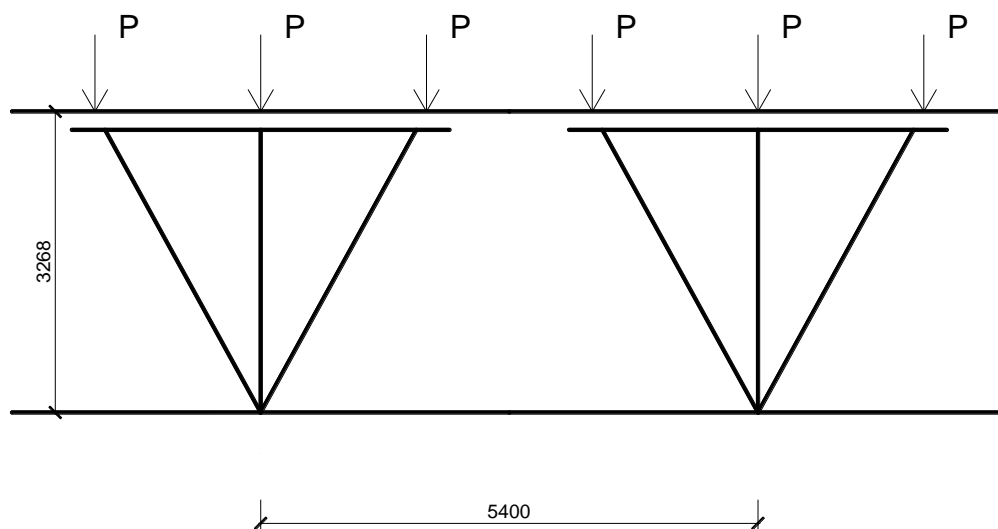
Розрахункова схема підкроквяних конструкцій
